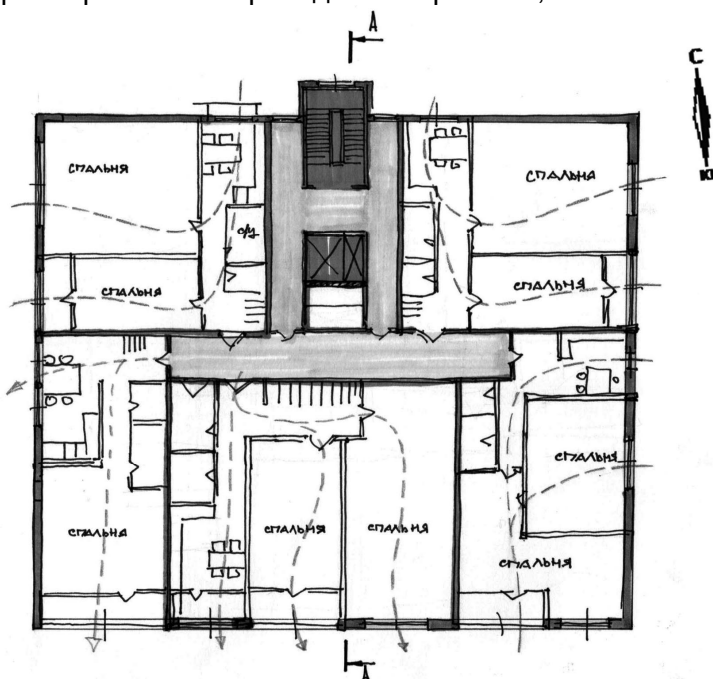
Эскиз плана типового этажа (рис. ст. Г.Фролова)
